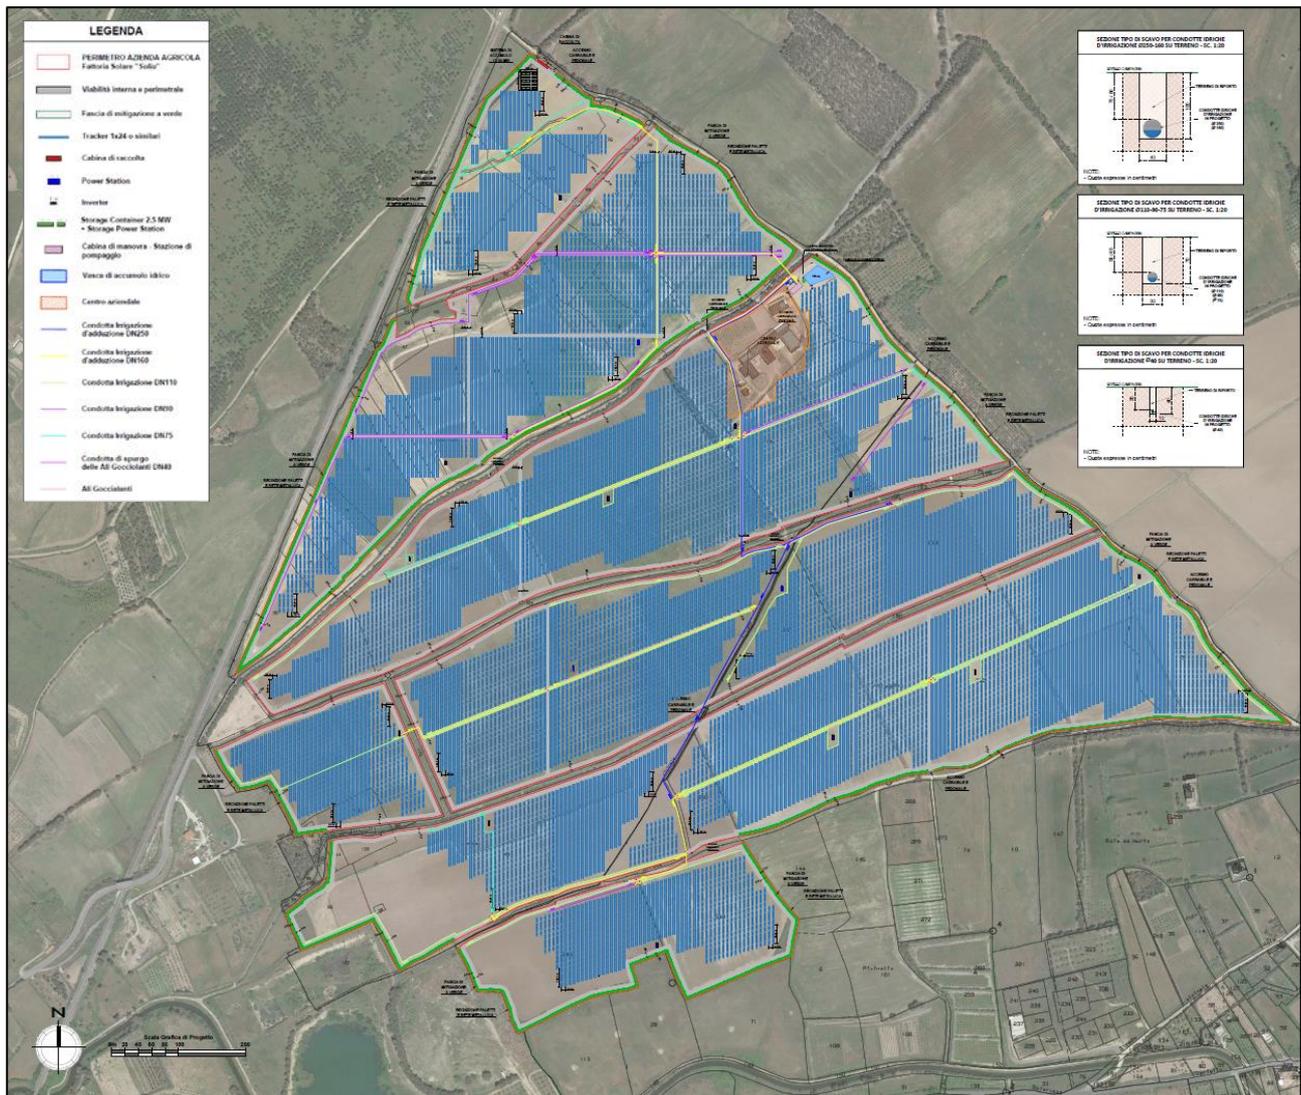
Layout dell'impianto di irrigazione, dal documento "2205_T.P.11a_Layout Impianto di Irrigazione-Fertirrigazione_Rev00".
